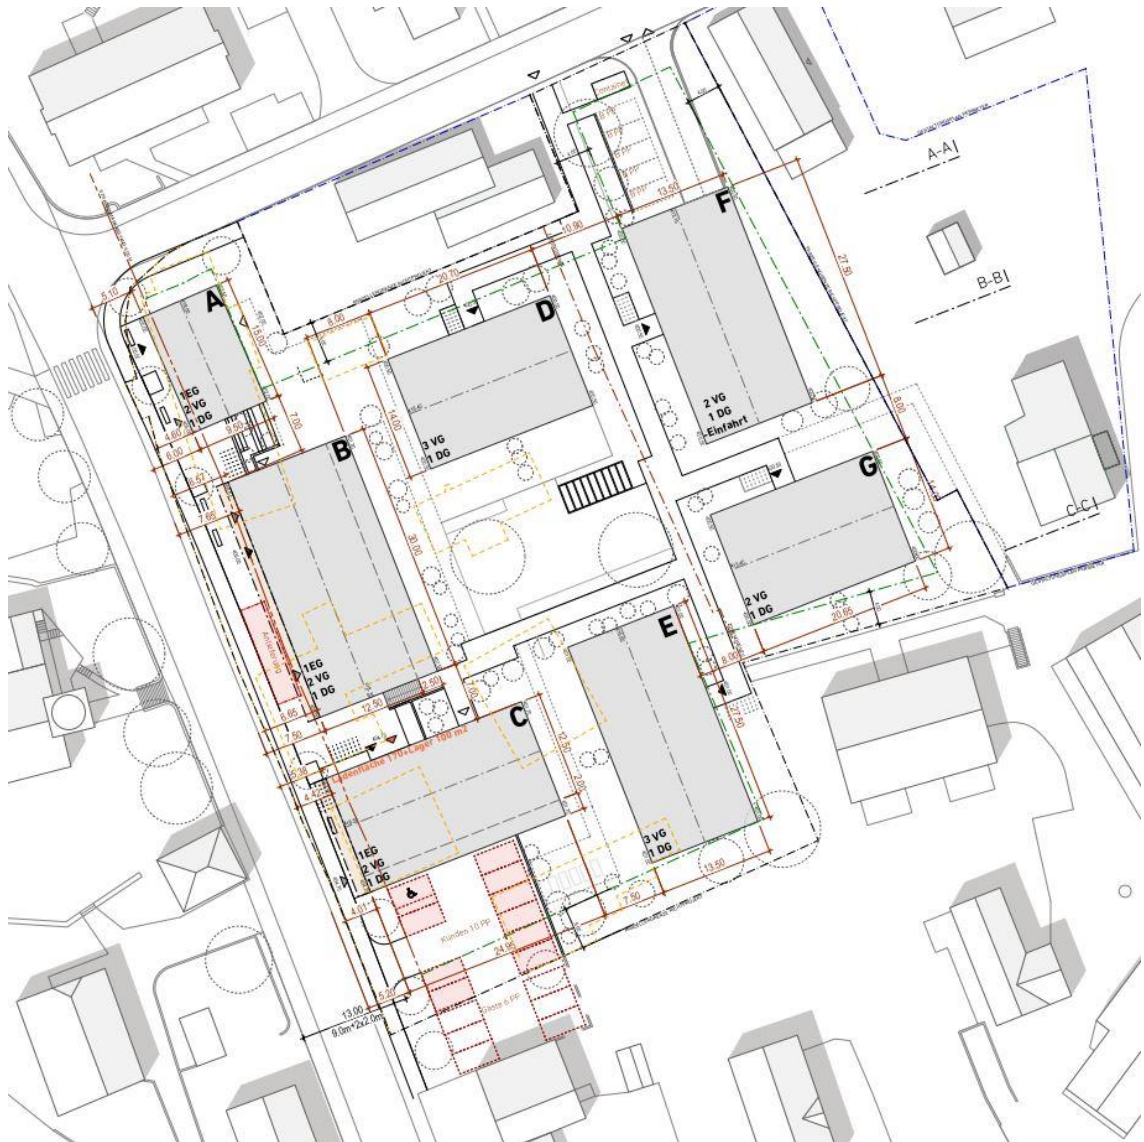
Plan Bebauung (Quelle: Roefs Architekten AG)
